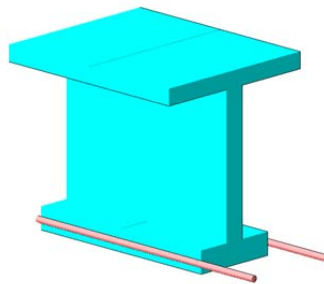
Розрахункова модель поперечного перерізу балки прогонової будови за типовим проектом «ВТП-16» з посиленням двома стержнями звичайної арматури
